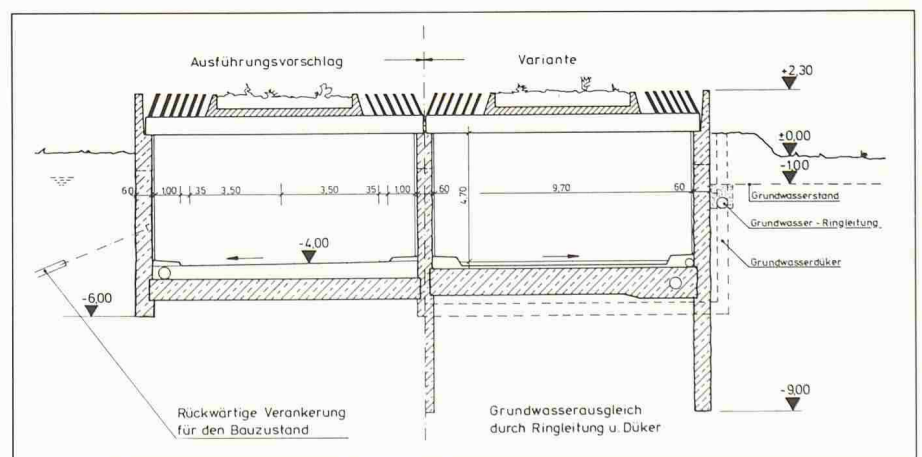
Lärmschutztunnel für die Bundesstrasse B 51, Umgehungsstrasse von Münster/Westf., mit Teilabdeckung, erbaut in offener Bauweise mit Schlitzwänden und Absenkung des Grundwasserspiegels (Voss)
